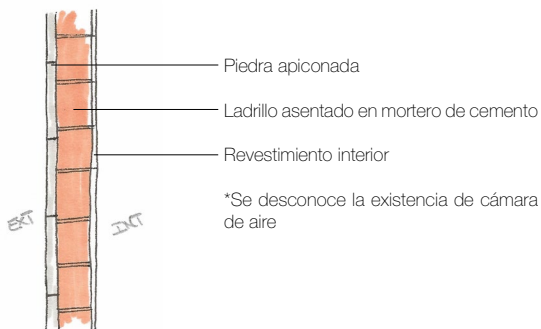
Sección de pared frontal acabado en piedra (autoría propia).
